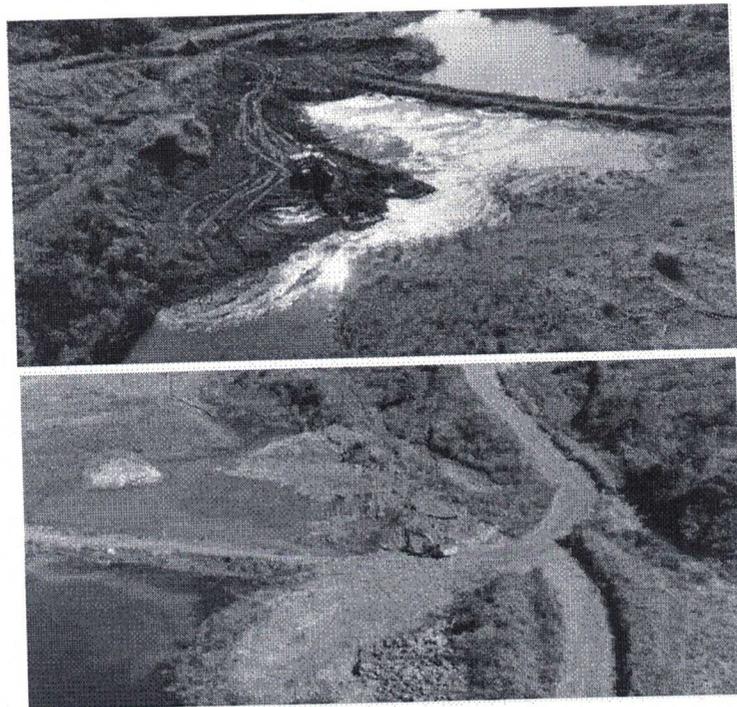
Início de desassoreamento do dreno de fundo da barragem Forquilha IV.
